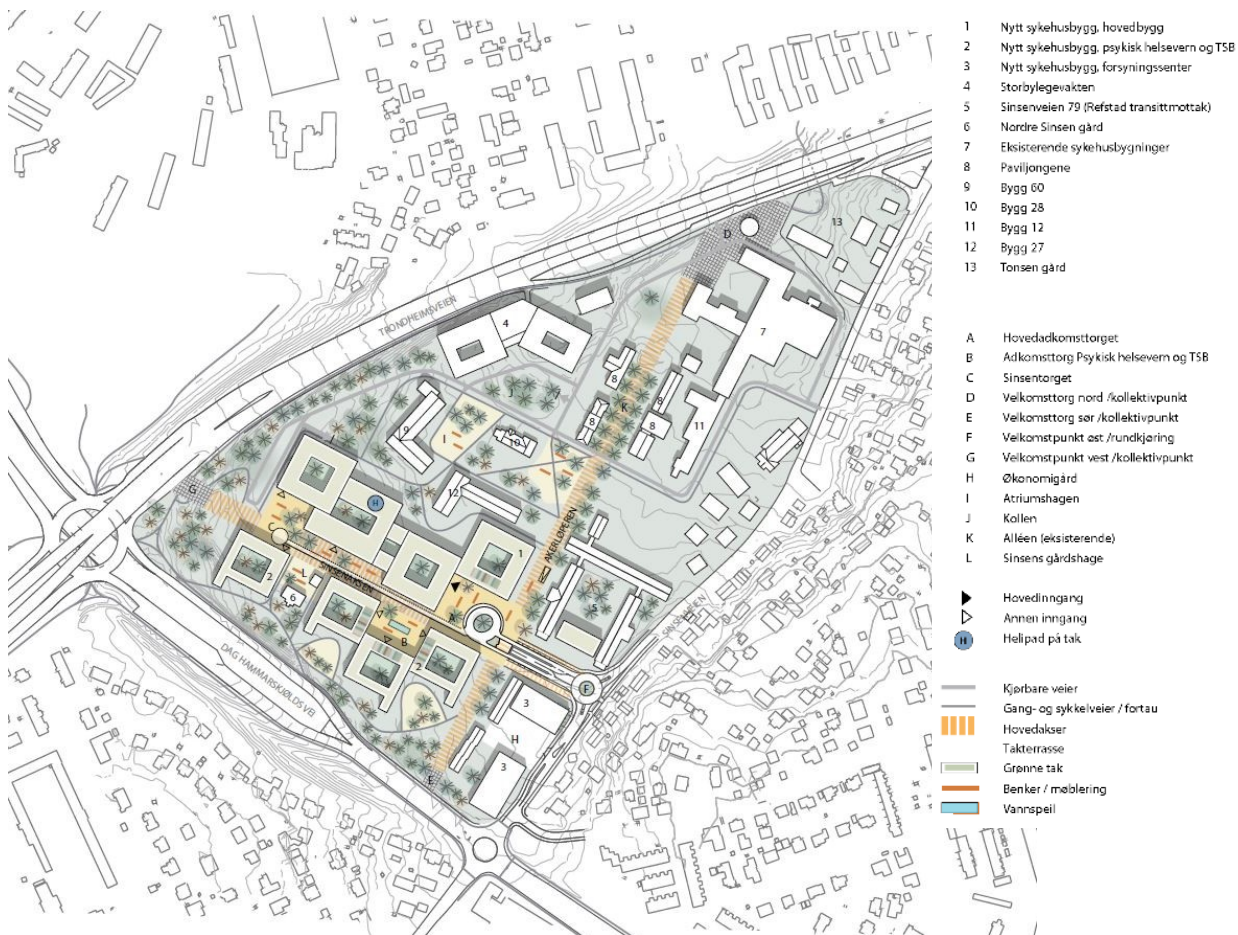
Situasjonsplan planalternativ 1B (Prosjekteringsgruppen, 2021)
